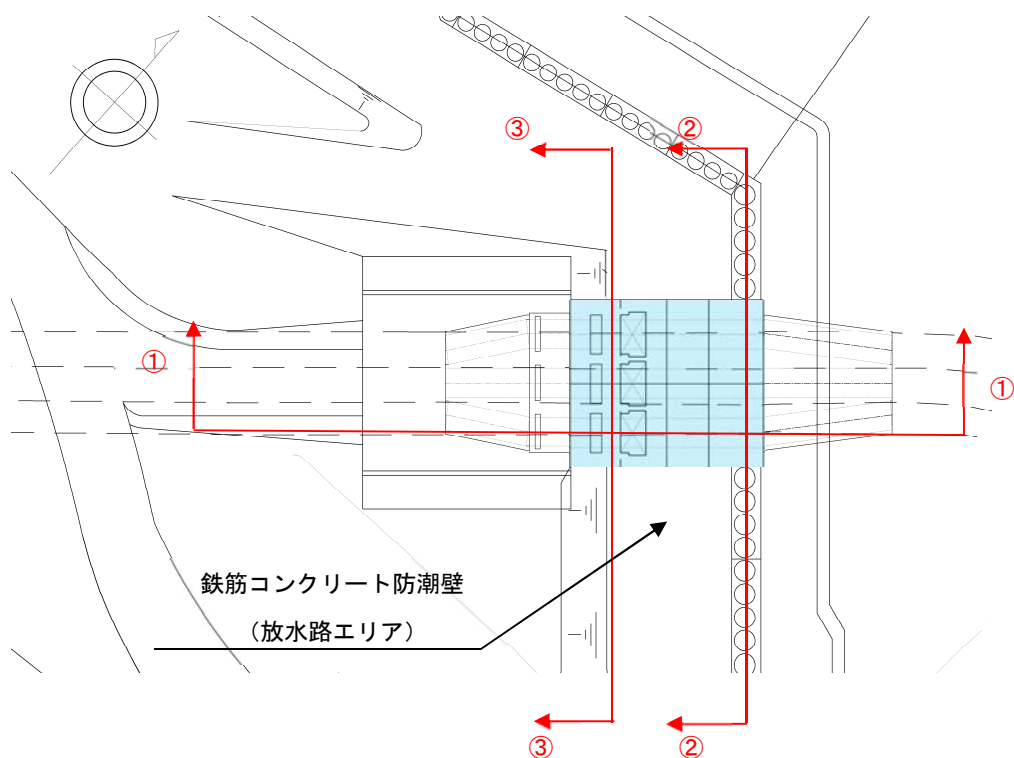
鉄筋コンクリート防潮壁（放水路エリア）の平面図
